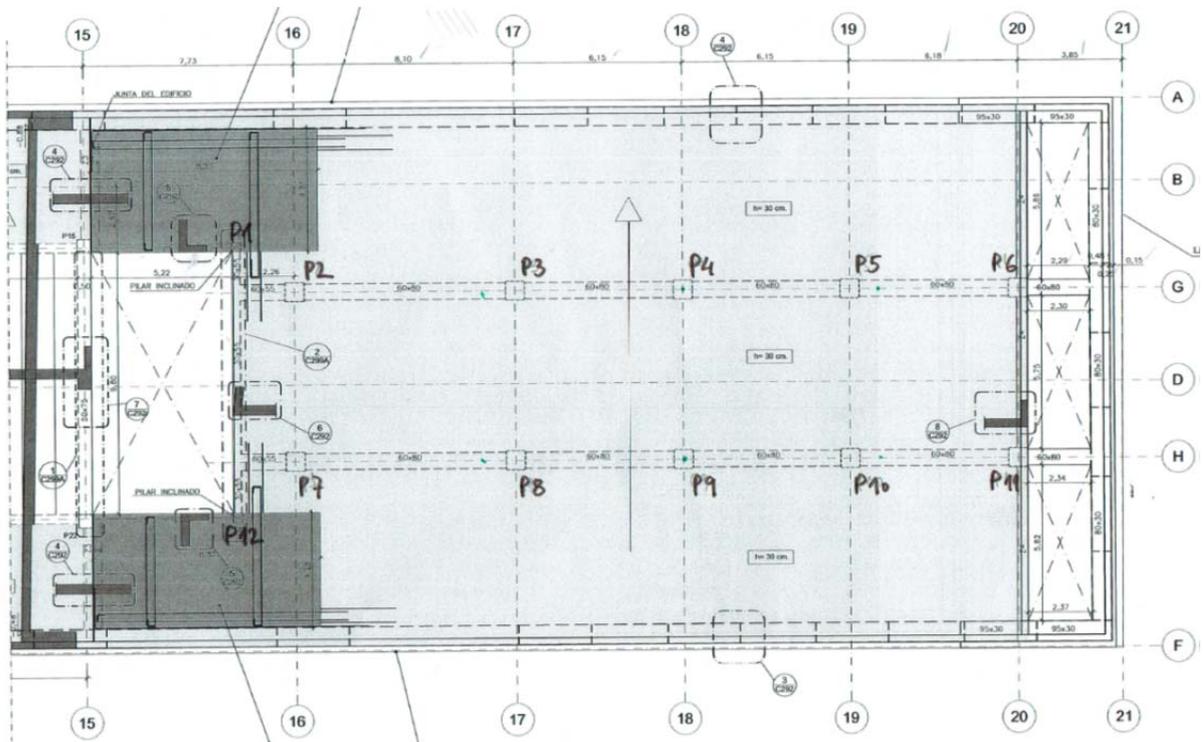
Geometría de estructura del techo de sótano-1 bajo el Pabellón, (Zona B).
